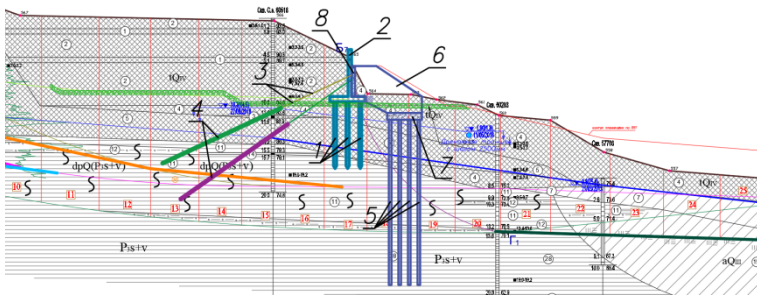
Вертикальная привязка свайных фундаментов (заглубленных железобетонных конструкций) в инженерно-геологический разрез:
